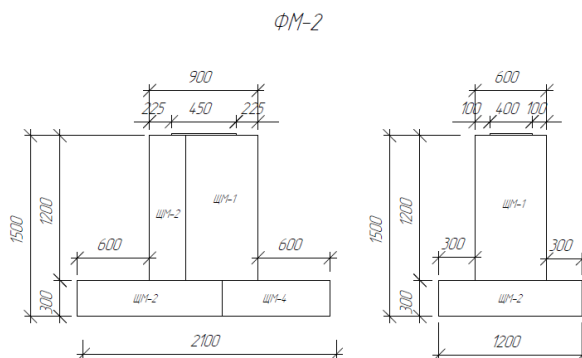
Расположение щитов опалубки для фундамента ФМ-2
